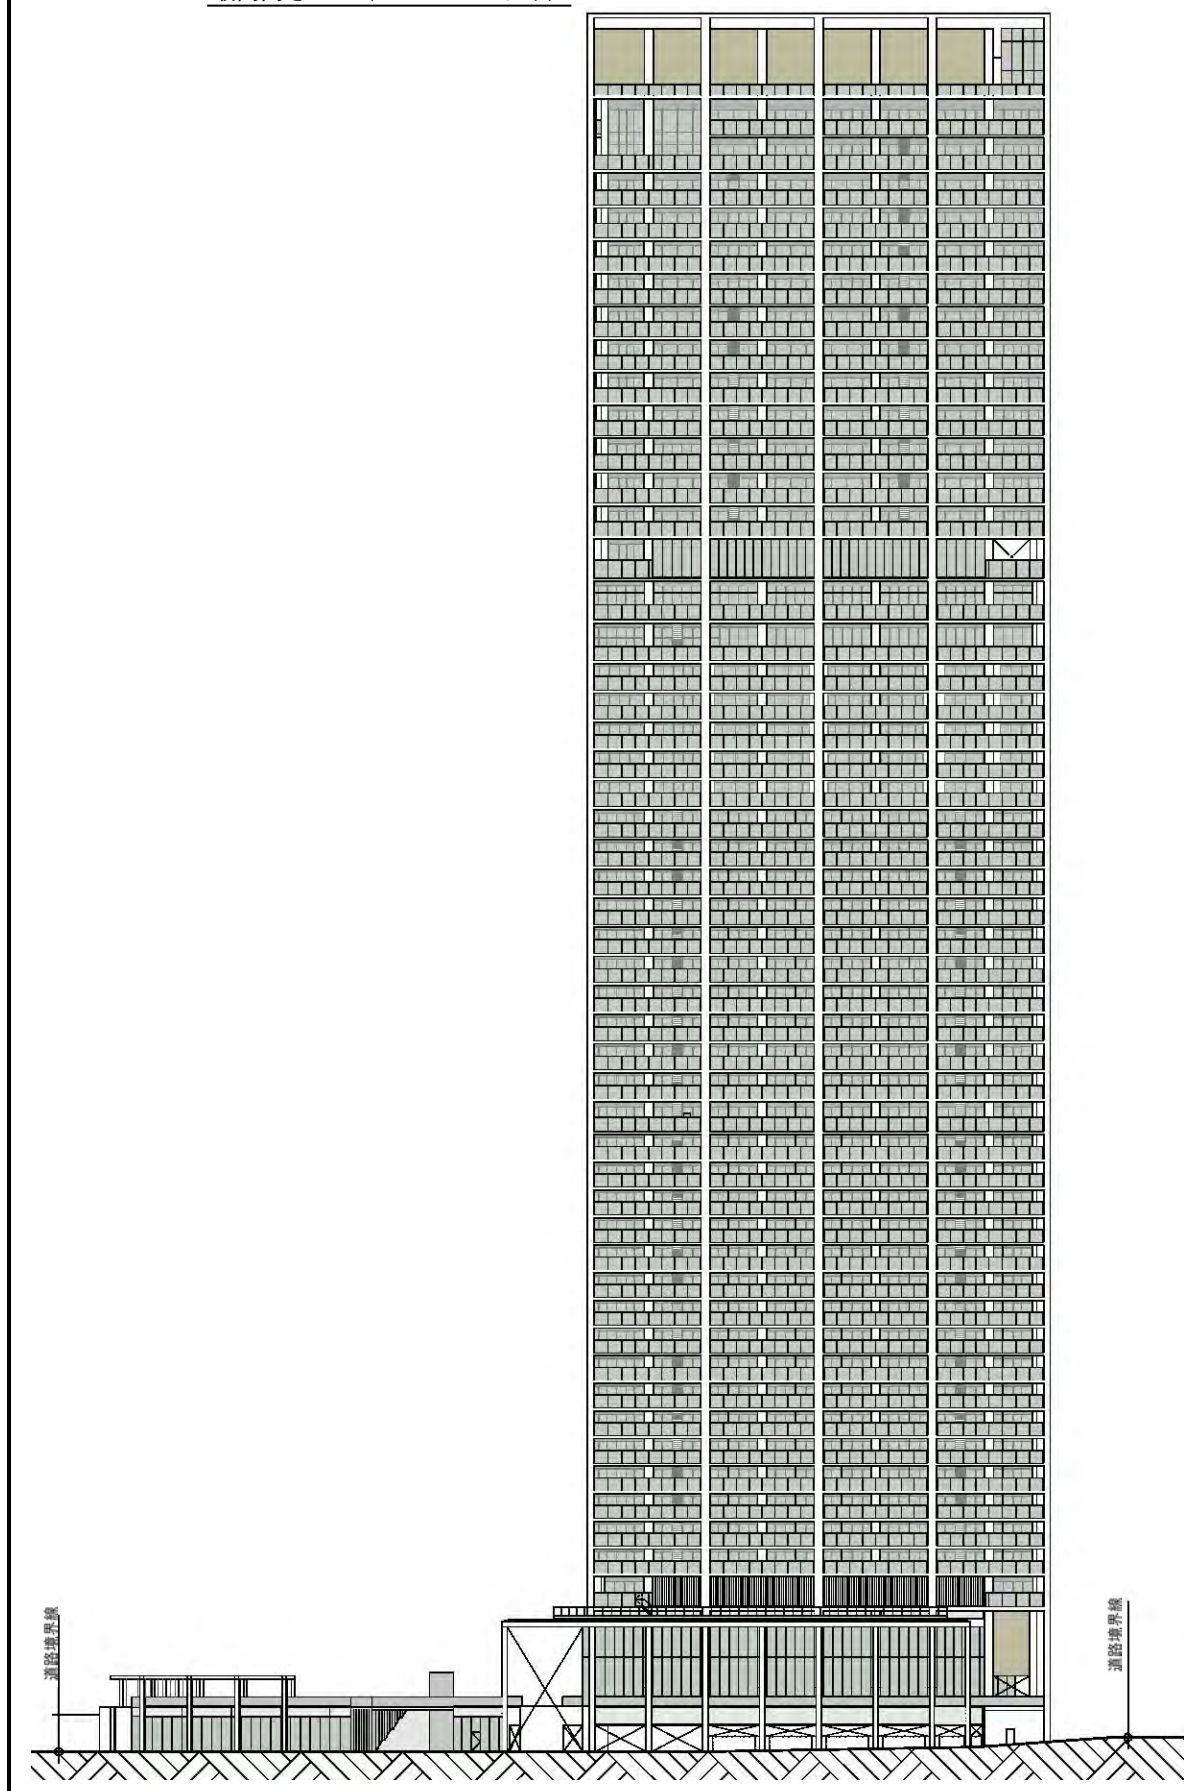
(4) 立面図（東立面図 S=1:1,000）【変更後】
